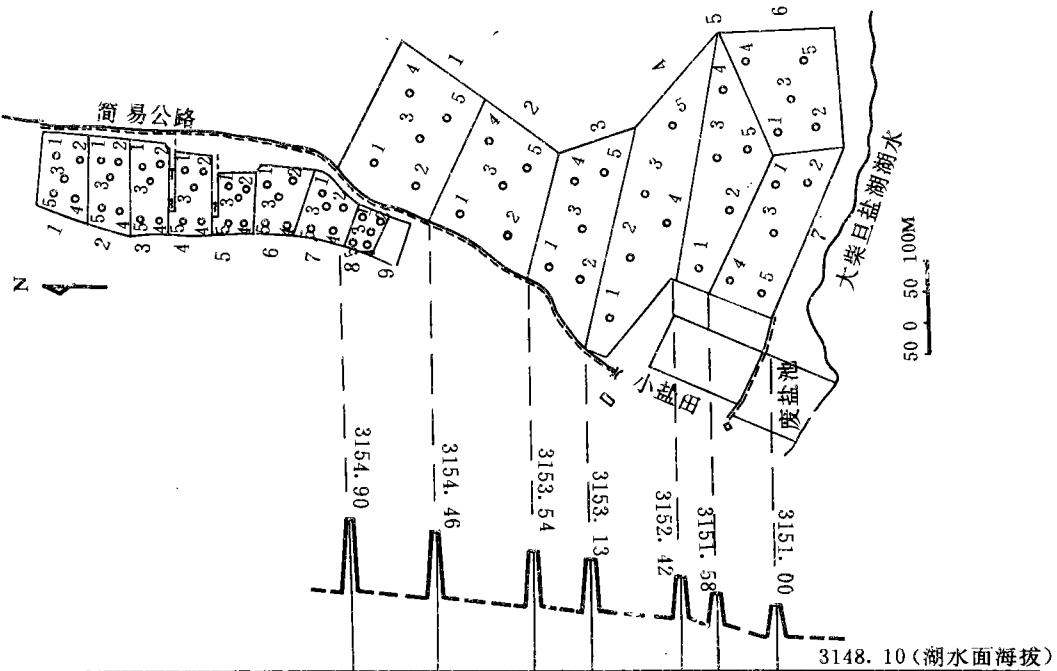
中试盐田平面布置图及氯化钠日晒池断面图
